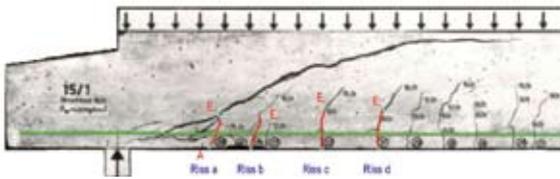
Ausschnittsvergrößerung des Balkens 15/1 aus [3] mit Kennzeichnung der Rissabschnitte A - E1 im Zustand II.1
